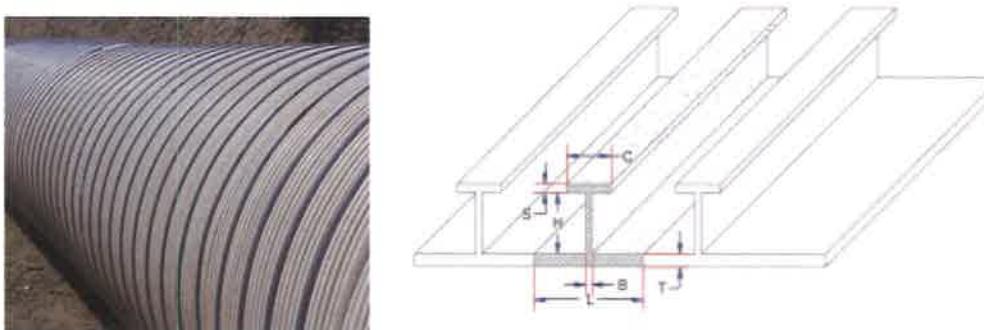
Sección Hidráulica tubería Rib Loc 1,200mm.
